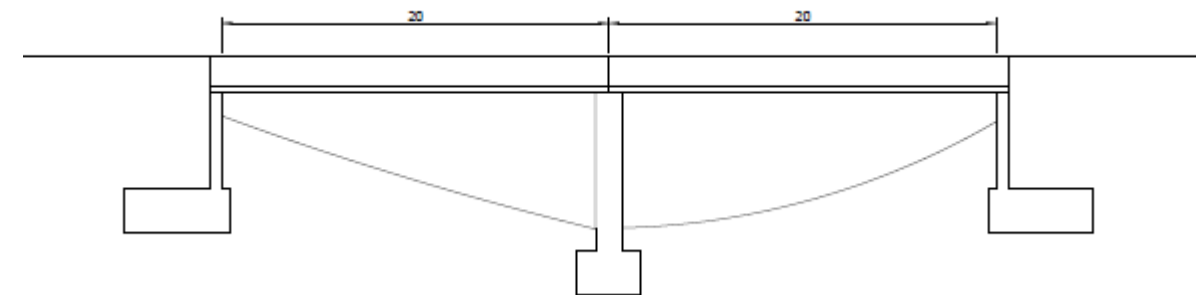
Esquema de distribución de vanos del puente norte. Fuente: Elaboración propia
